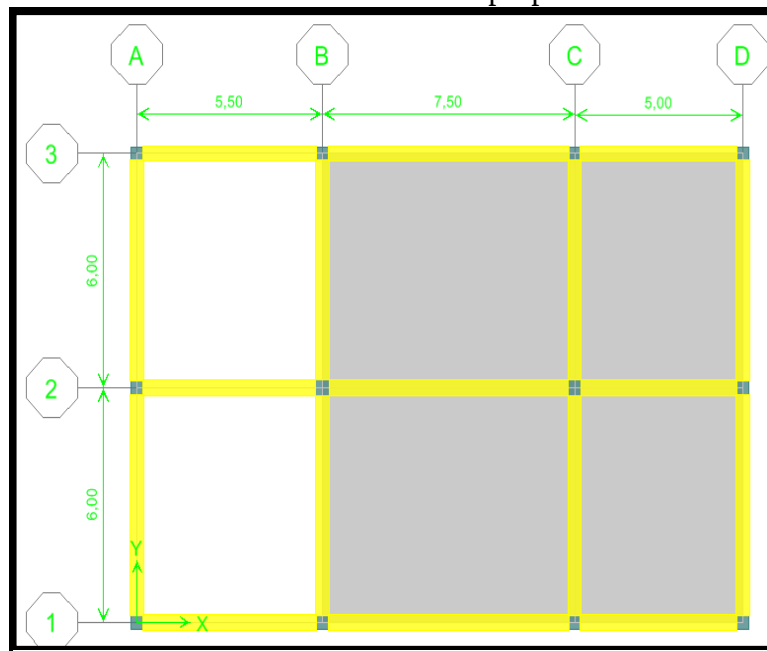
Planta de Nueva Configuración Pasarela 1 (Edificio Sur-Oeste)
